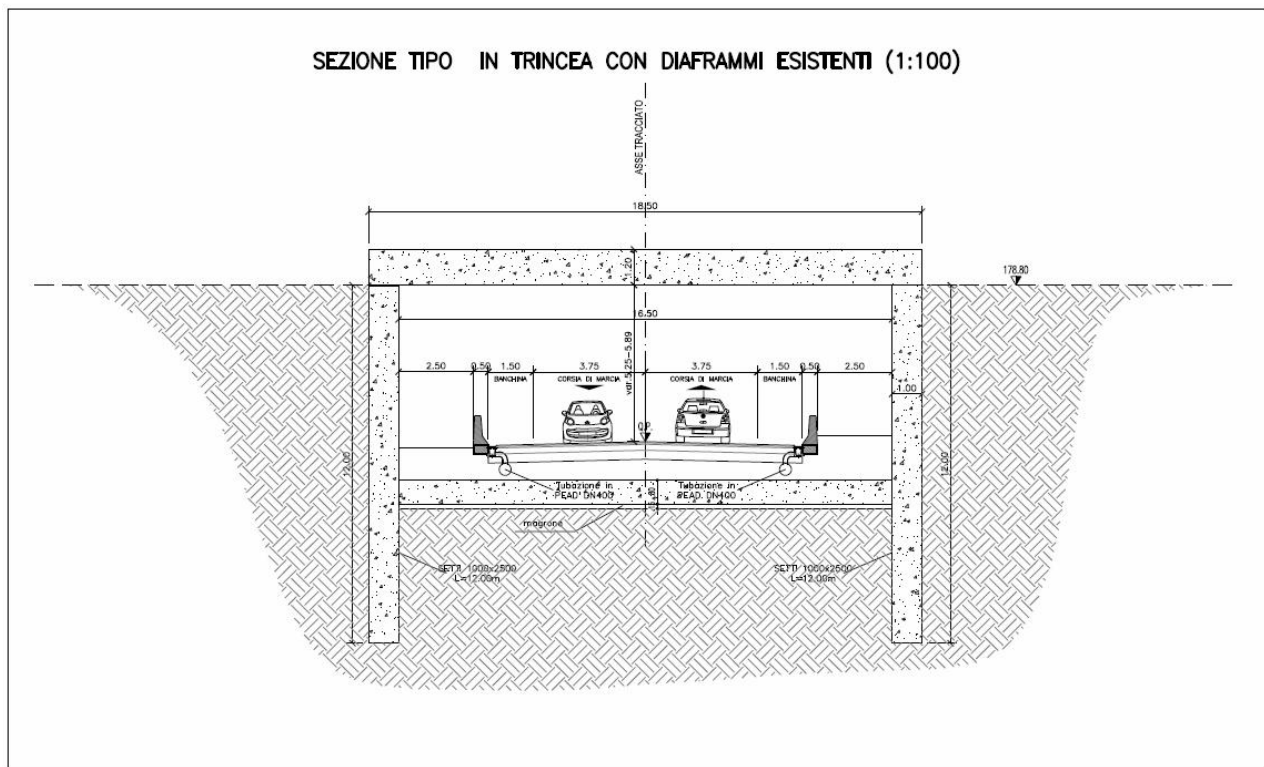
Sezione tipo - Galleria artificiale S.P.n.101
